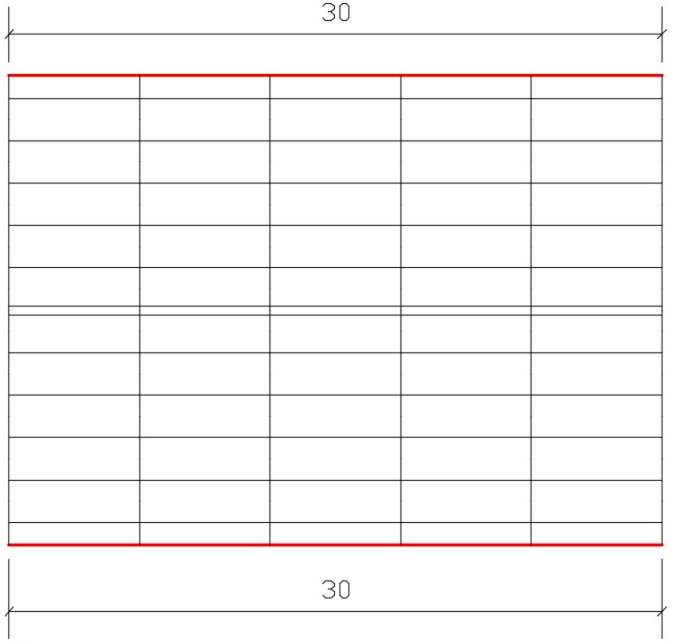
Vista en planta de la cubierta, resaltando los bordes donde se colocará canal
